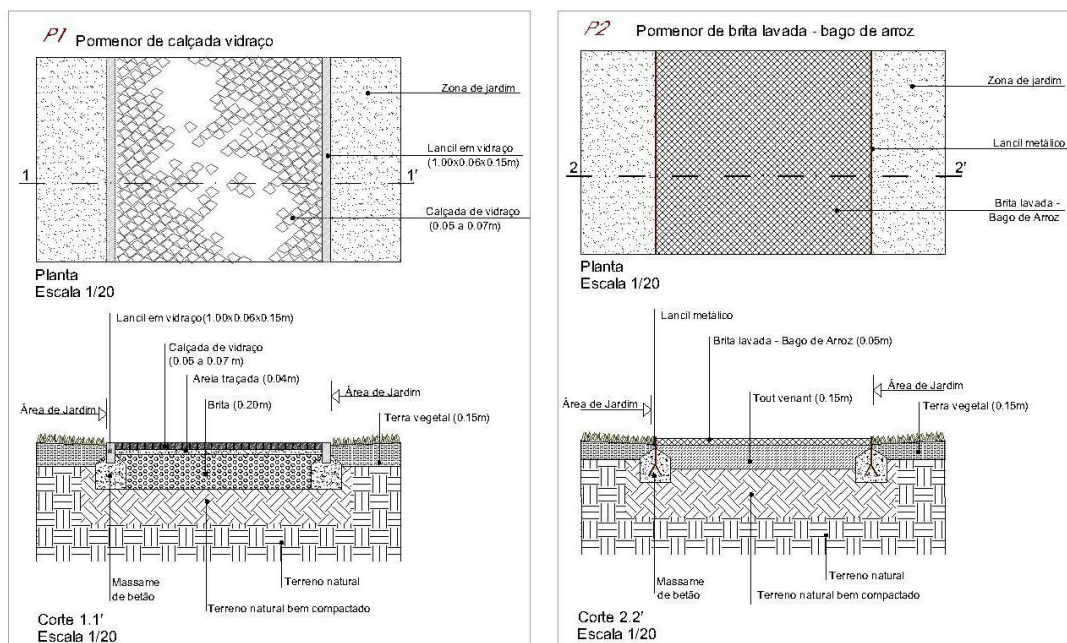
exemplo de pormenores construtivos de dois tipos de pavimento com respectivos cortes e plantas
